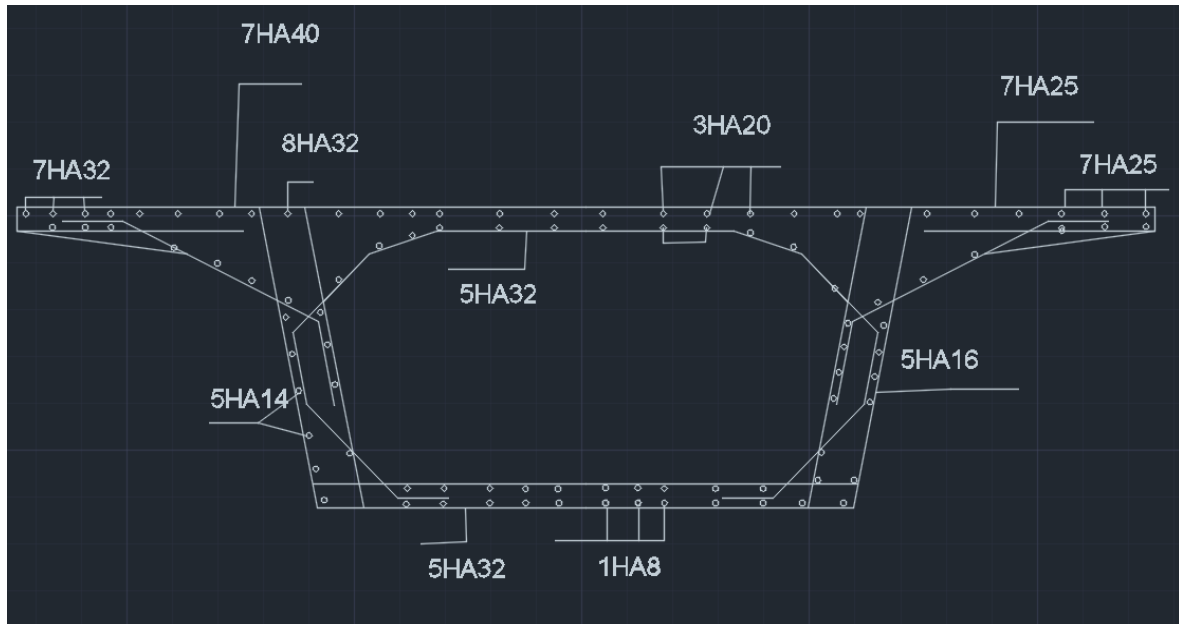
Schéma de ferrailage du voussoir à la clé
